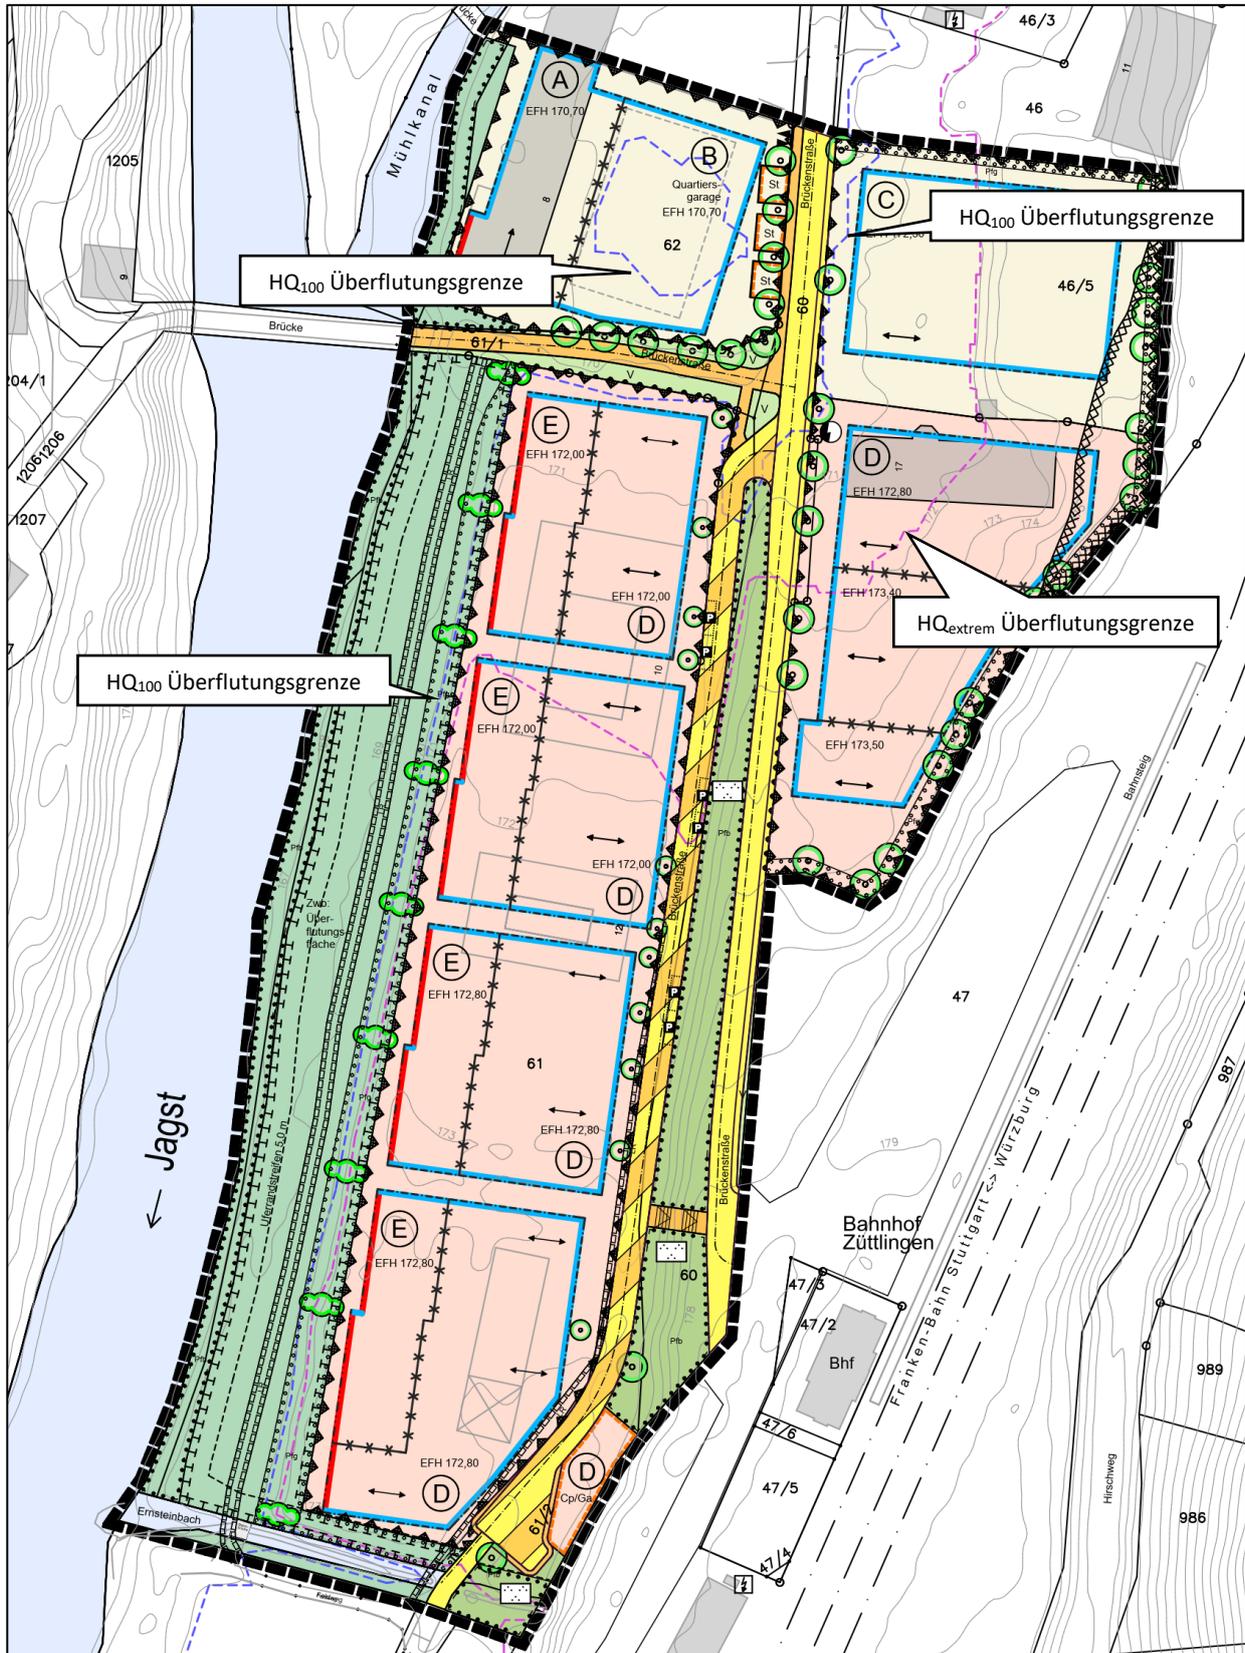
„Geltungsbereich BP Brückenstraße 1. Änd.“ Auszug Bebauungsplan
